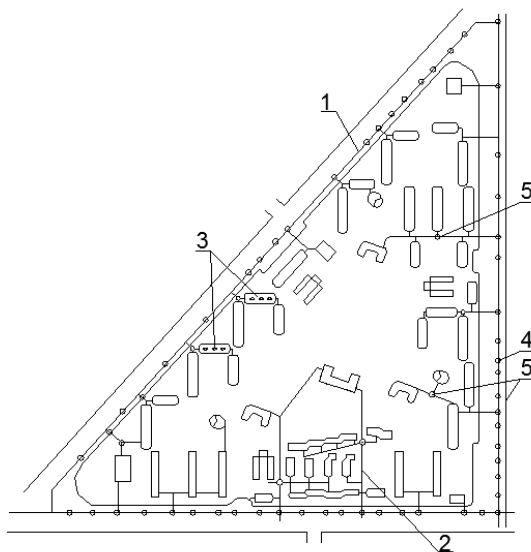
Схема внутриквартальной водопроводной сети: 1 — уличная водопроводная сеть; 2 — внутриквартальная сеть с вводами в каждое здание; 3 — частичная прокладка трубопроводов через здания транзитом; 4 — колодцы на наружной сети; 5 — наружные поливочные краны на внутренней сети; 6 — колодцы на внутриквартальной сети.
